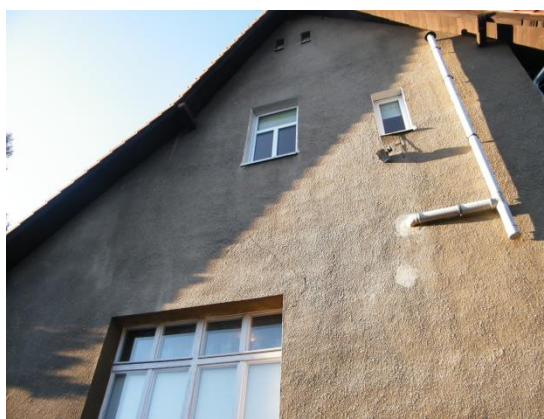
Widok na elewację frontową – uszkodzenia tynku , widoczna elewacja wejścia , do oczyszczenia i konserwacji.
